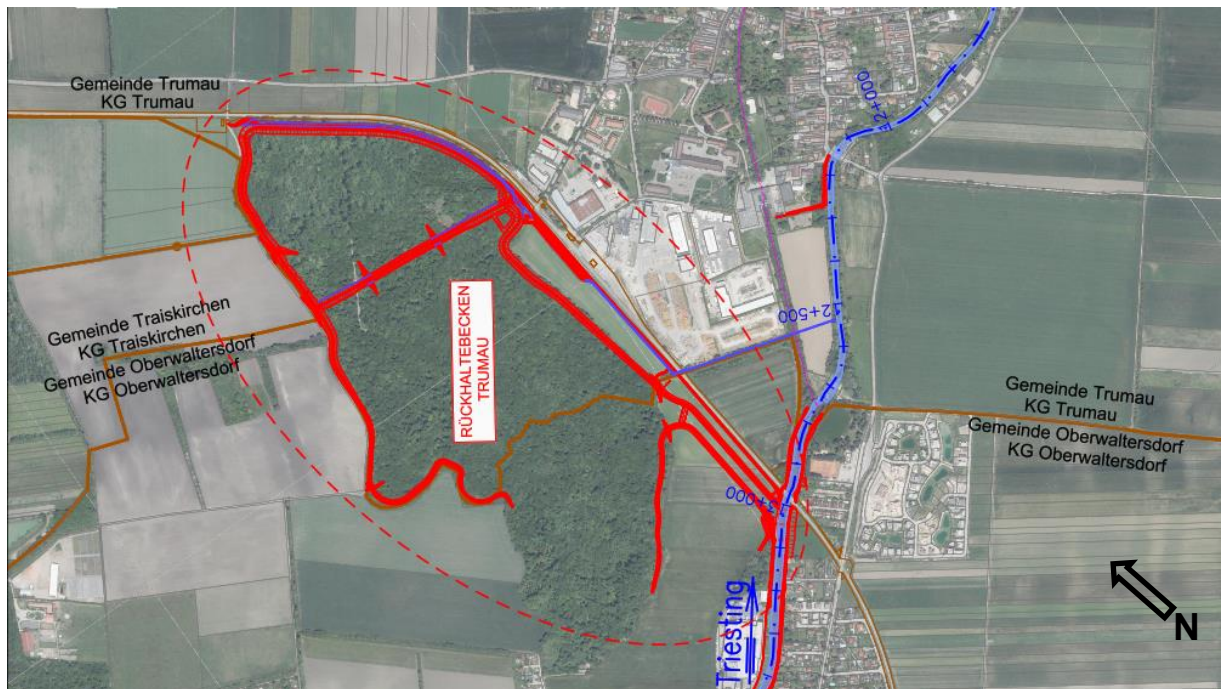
Projektstandort Rückhaltebecken Trumau, Ausschnitt aus S-00-WB-200-ST-00 Gesamtübersichtsplan [20].
